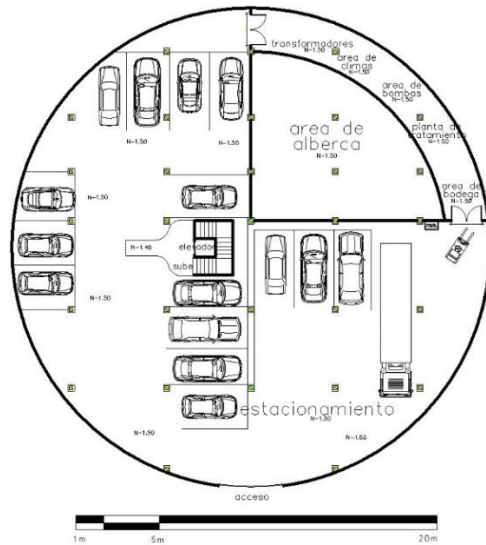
Planta arquitectónica de estacionamiento en el nivel 1
